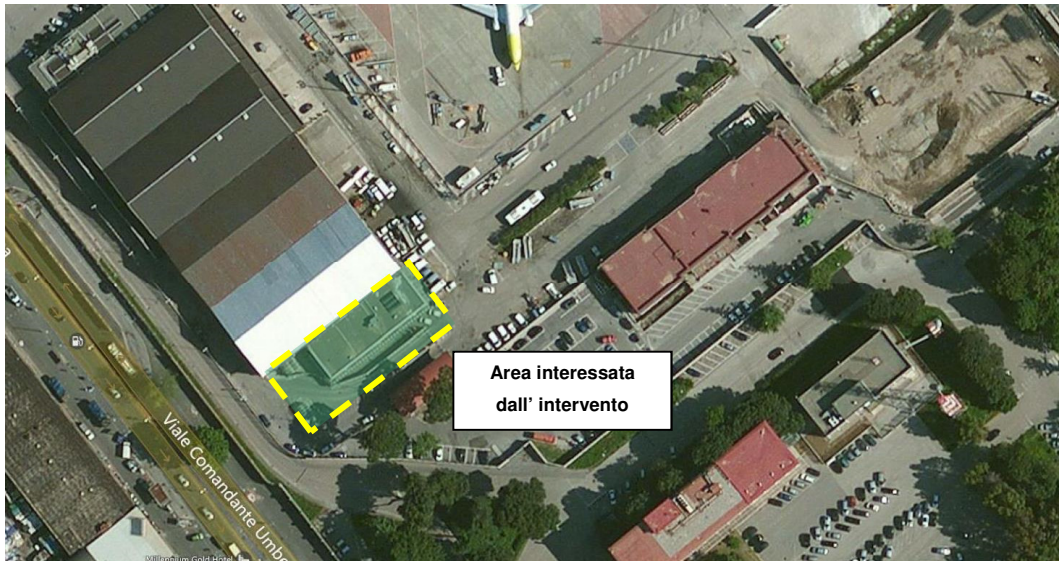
Vista aerea con individuazione dell'area di intervento
